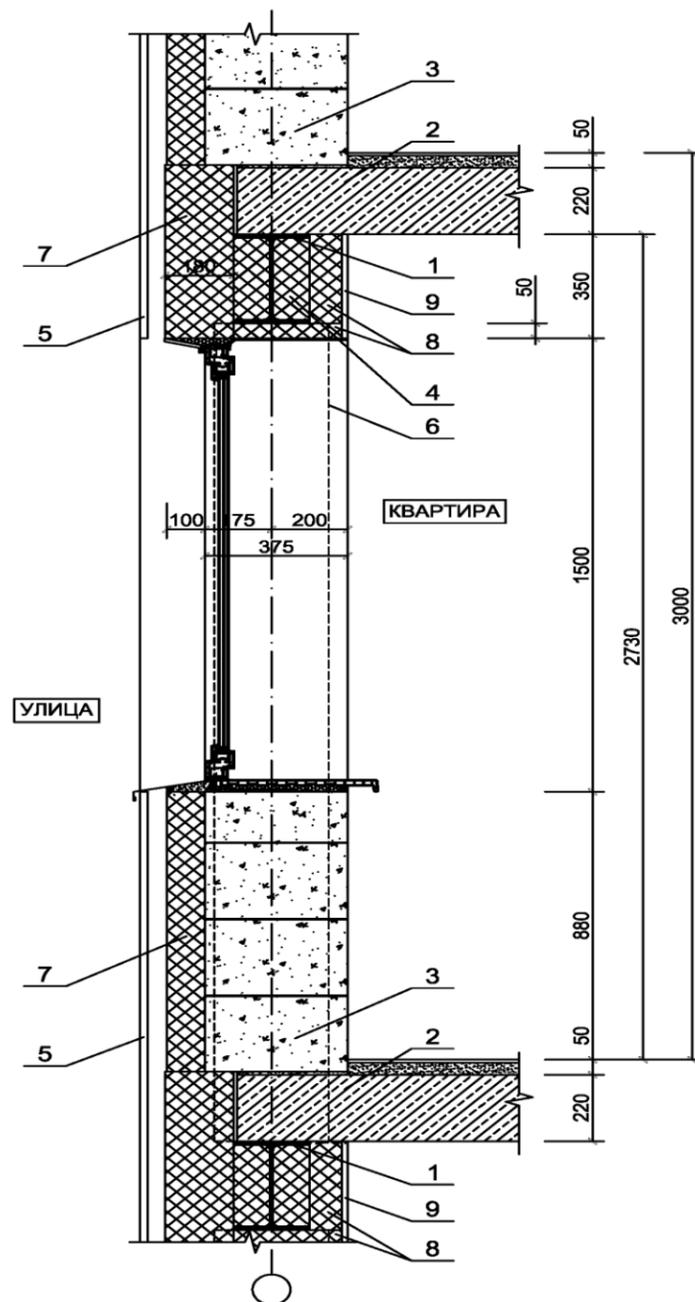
Защита балок (ригелей) от огня у наружной стены.
